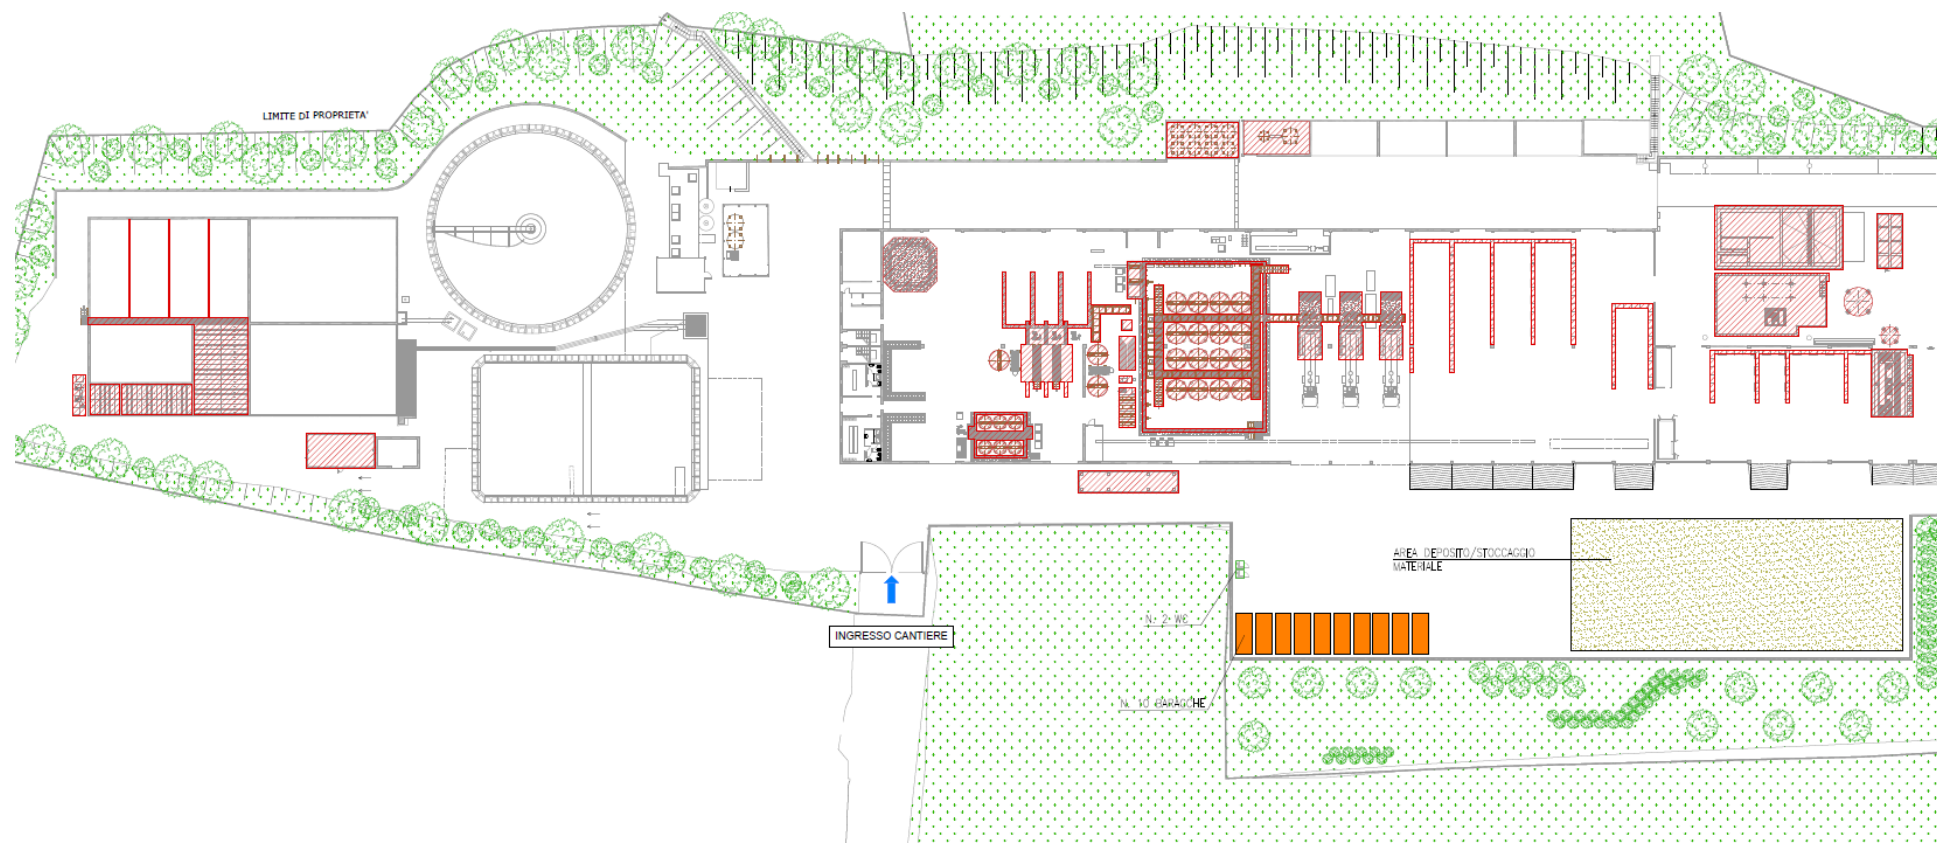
Planimetria area di cantiere durante la fase di cantiere numero 3 (Realizzazione delle opere civili di preparazione del sito) [Fonte: stralcio elaborato PD A.3]
